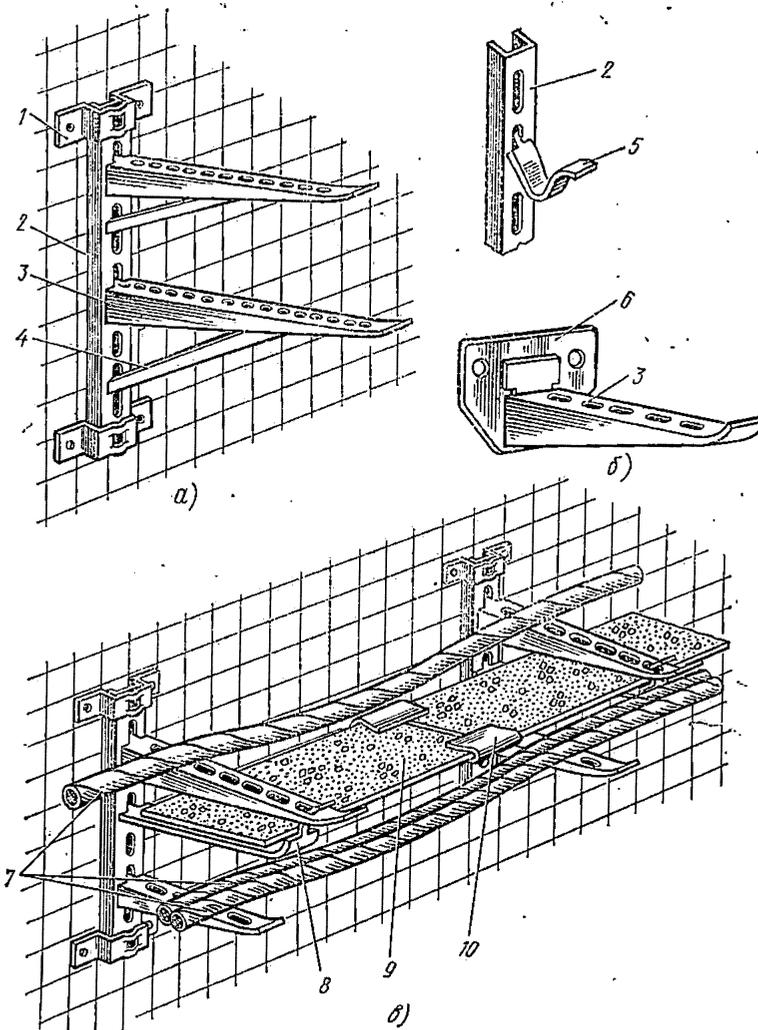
Прокладка кабелей на опорных конструкциях:
